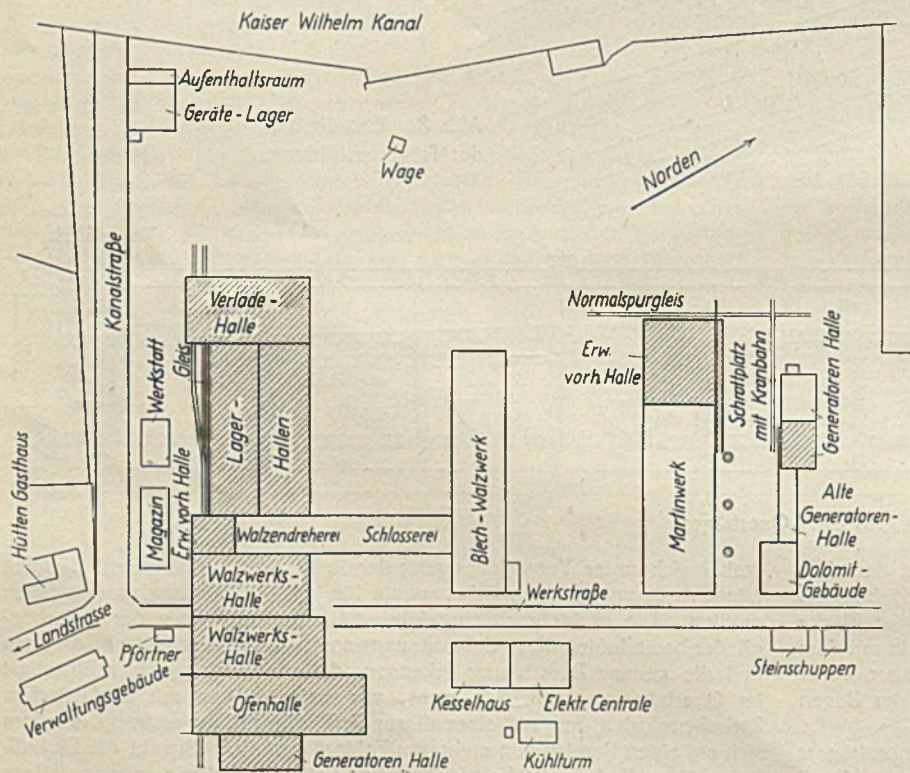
Gesamtanlageplan (die neuen Hallenbauten sind schraffiert dargestellt).
